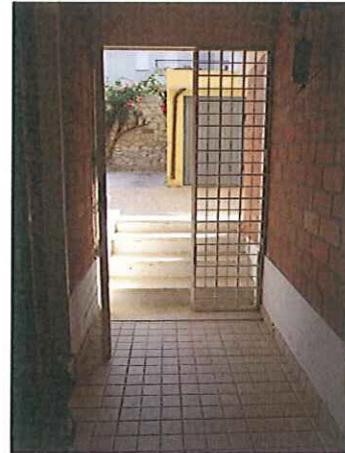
Visuale dall'interno dell'accesso al bene
